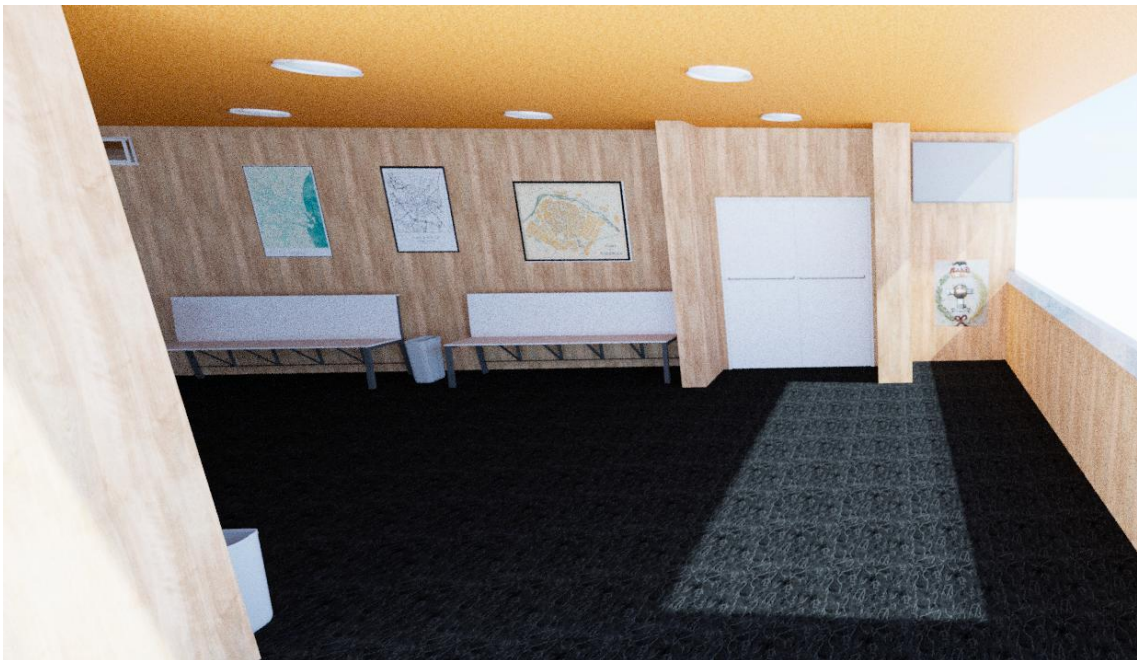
Imagen 6 Renderizado Pasillo Planta Baja Fuente: Elaboración Propia
